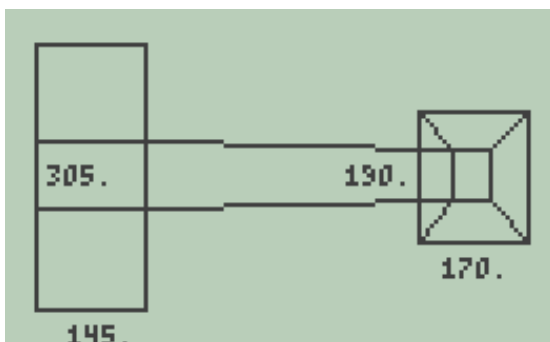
Viga alavanca - Detalhamento das sapatas e da viga em planta.
